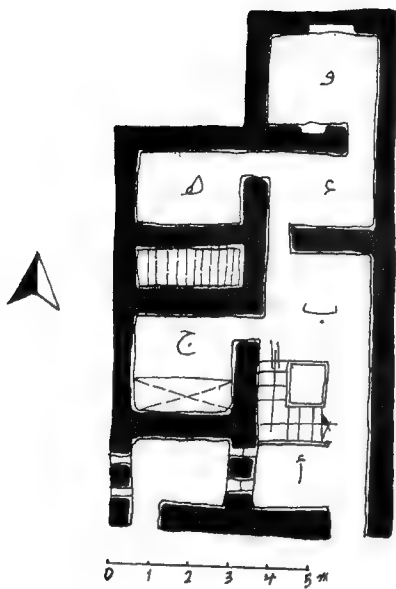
منزل محمد زيهان الدور الأرضي المستوى الثاني - مسقط أفقي
